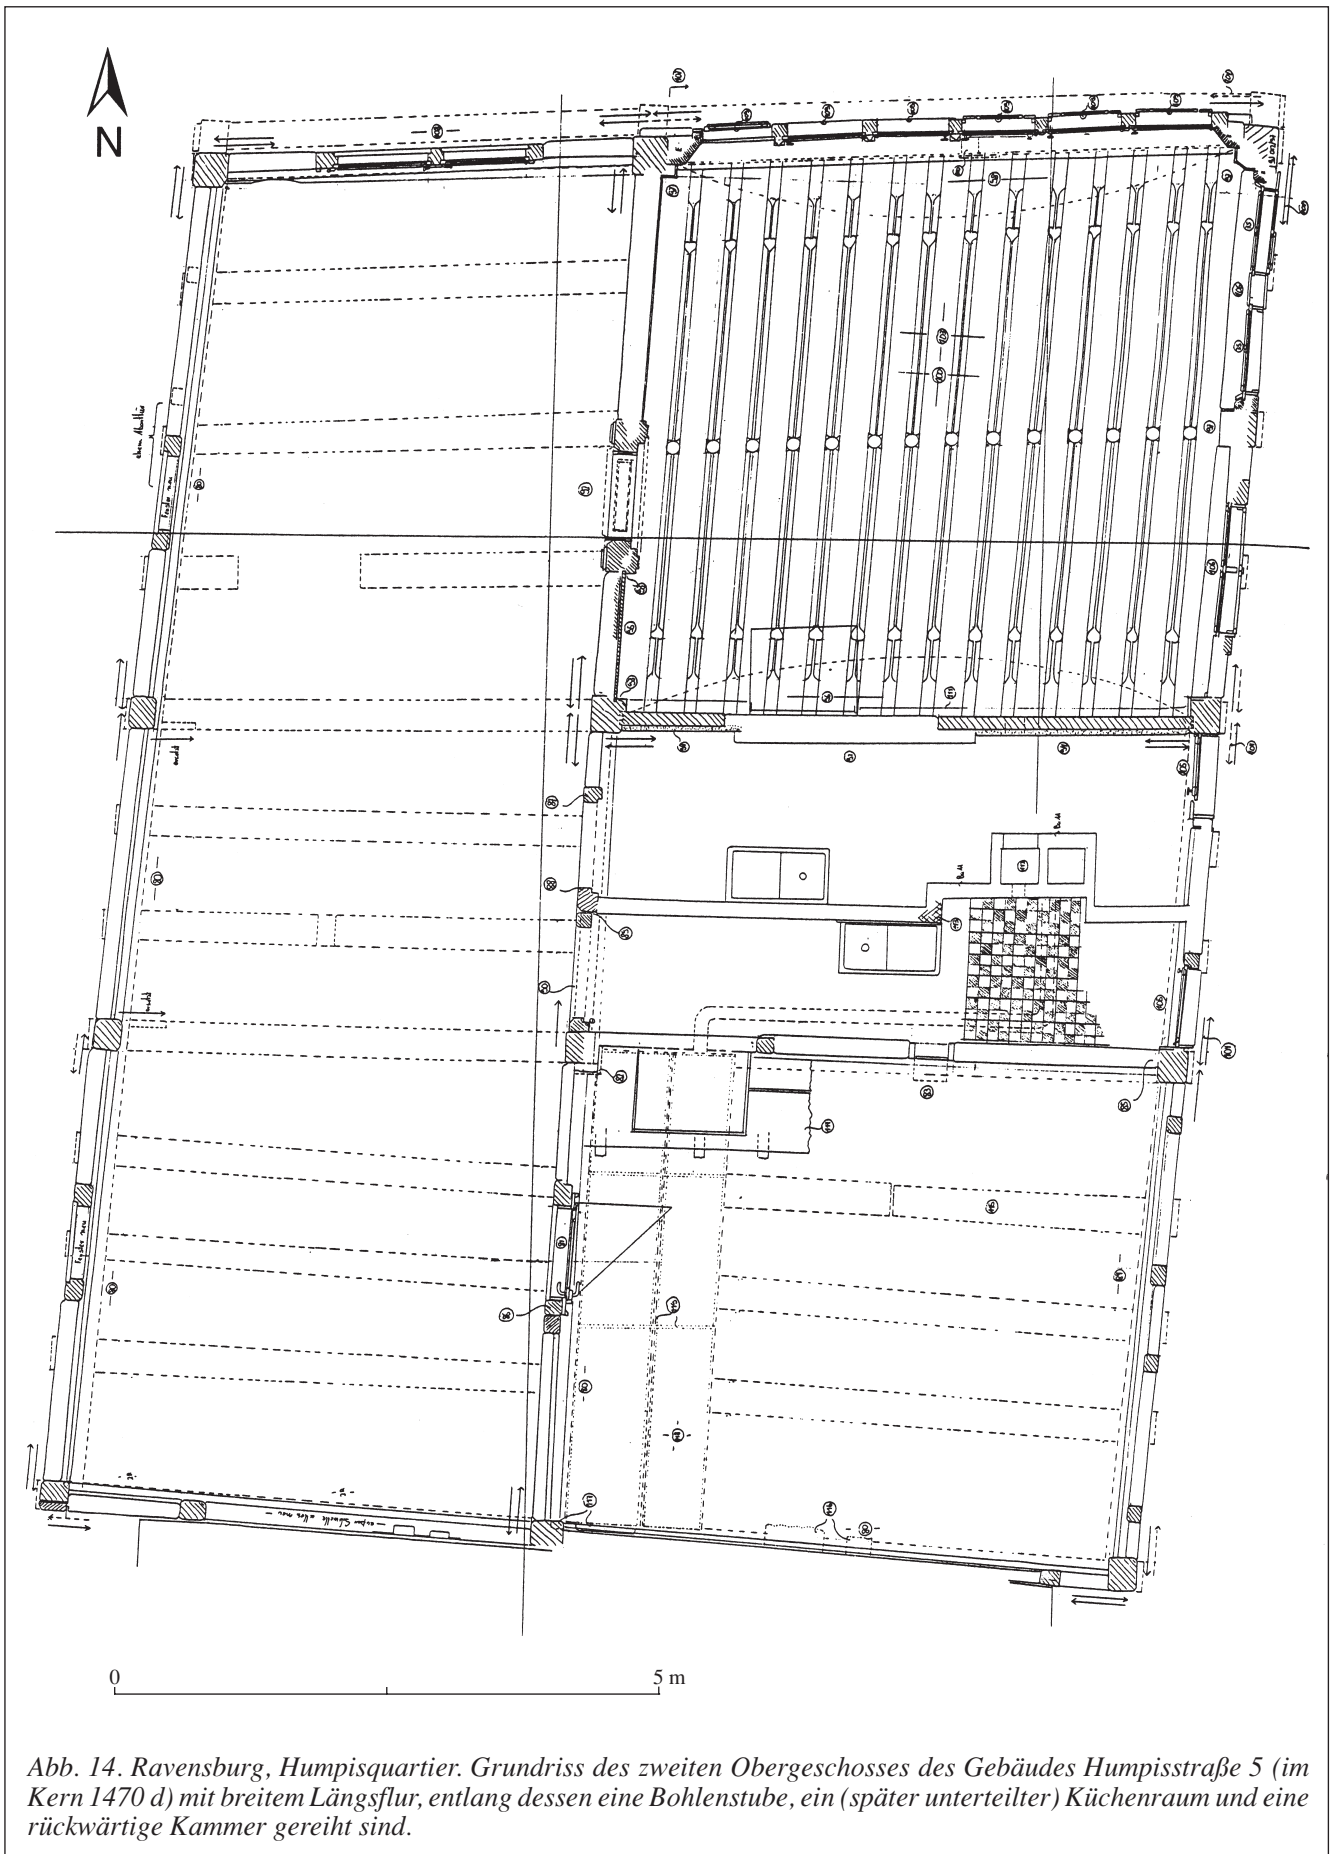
Ravensburg, Humpisquartier. Grundriss des zweiten Obergeschosses des Gebäudes Humpisstraße 5 (im Kern 1470 d) mit breitem Längsflur, entlang dessen eine Bohlenstube, ein (später unterteilter) Küchenraum und eine rückwärtige Kammer gereiht sind.
